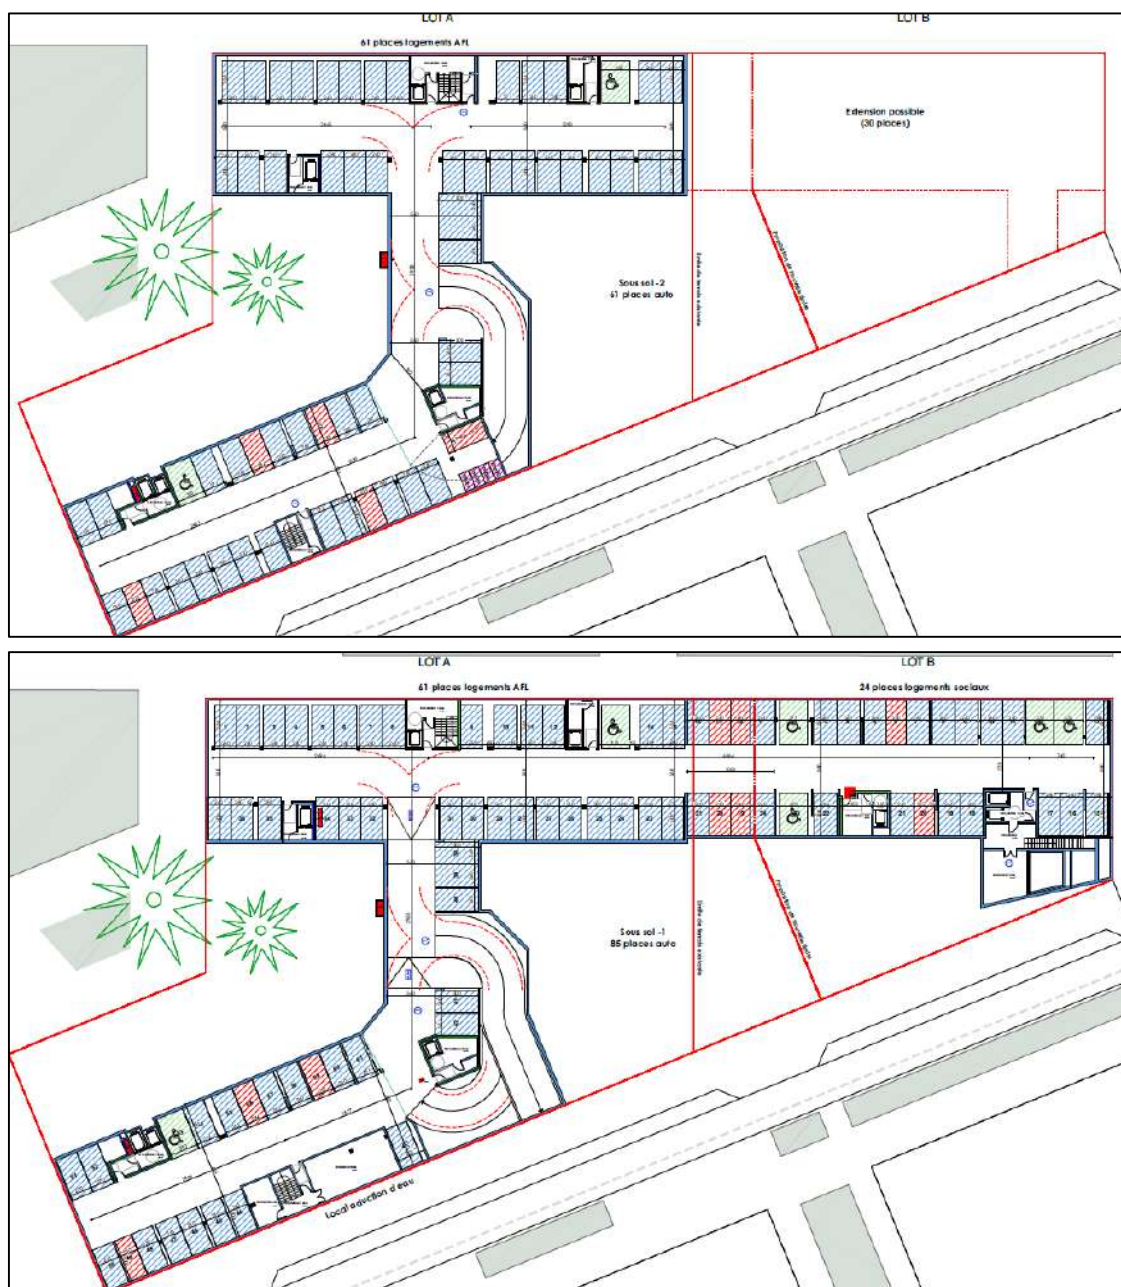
Plans des sous-sols et stationnement (Source : VERRECCHIA)c
